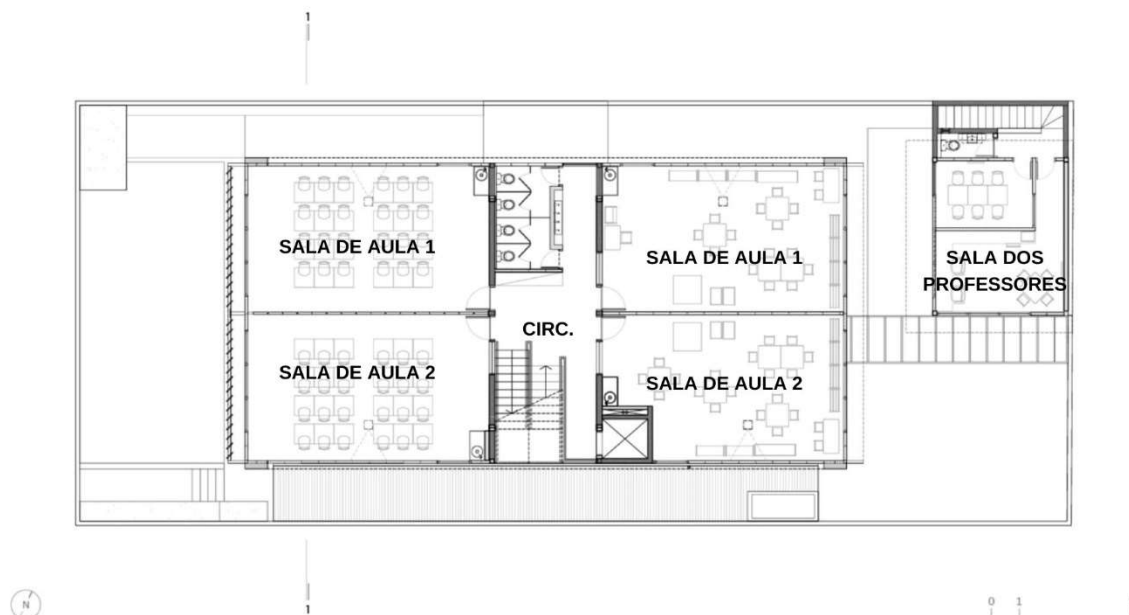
Planta baixa pav. térreo da Escola em Alto Pinheiros
